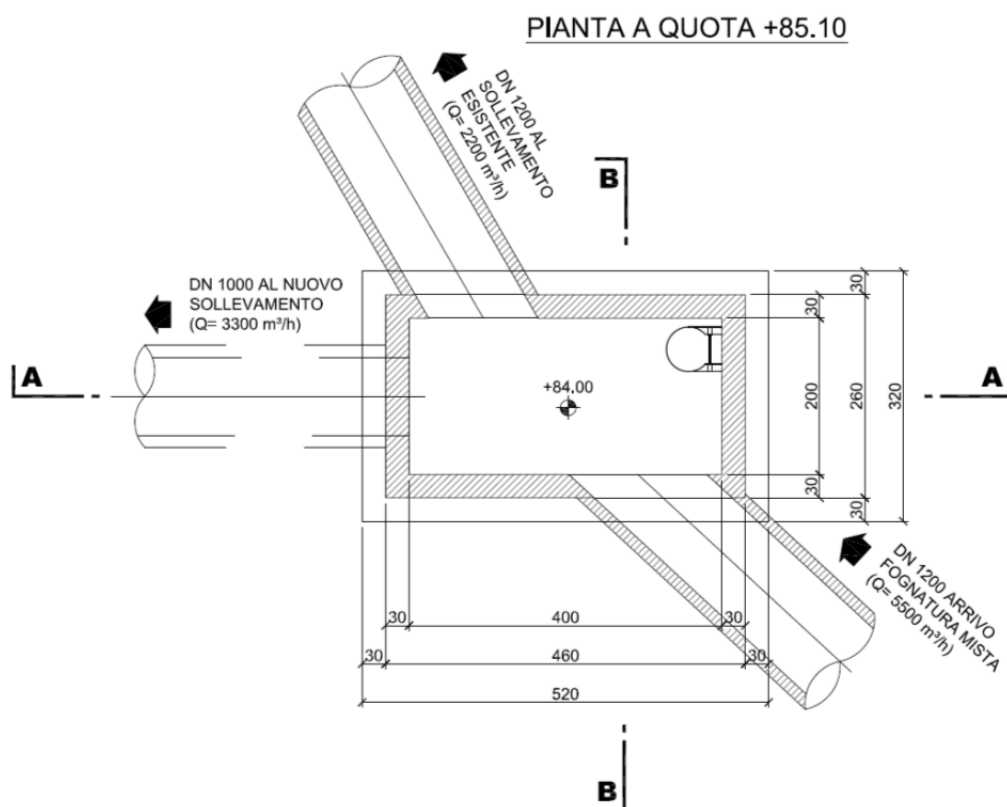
POZZETTO RIPARTITORE AI PRETRATTAMENTI – PIANTA
